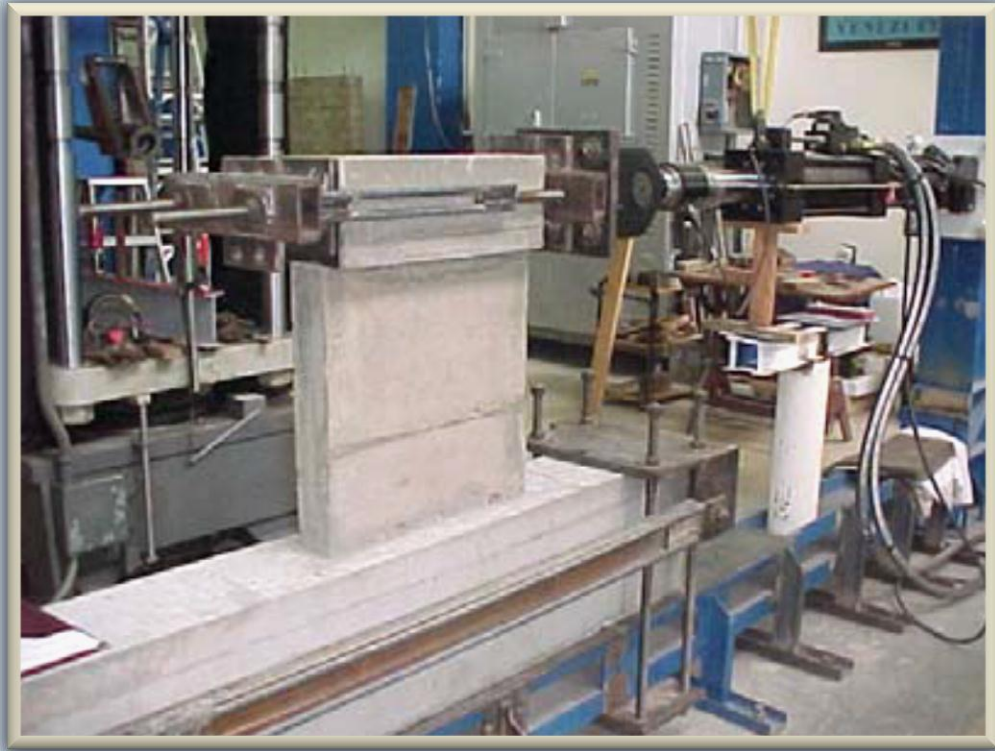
e.2-1) Ensayo para simular acción de carga lateral (sismo) en muro de concreto reforzado. Formación de grietas por tensión diagonal
